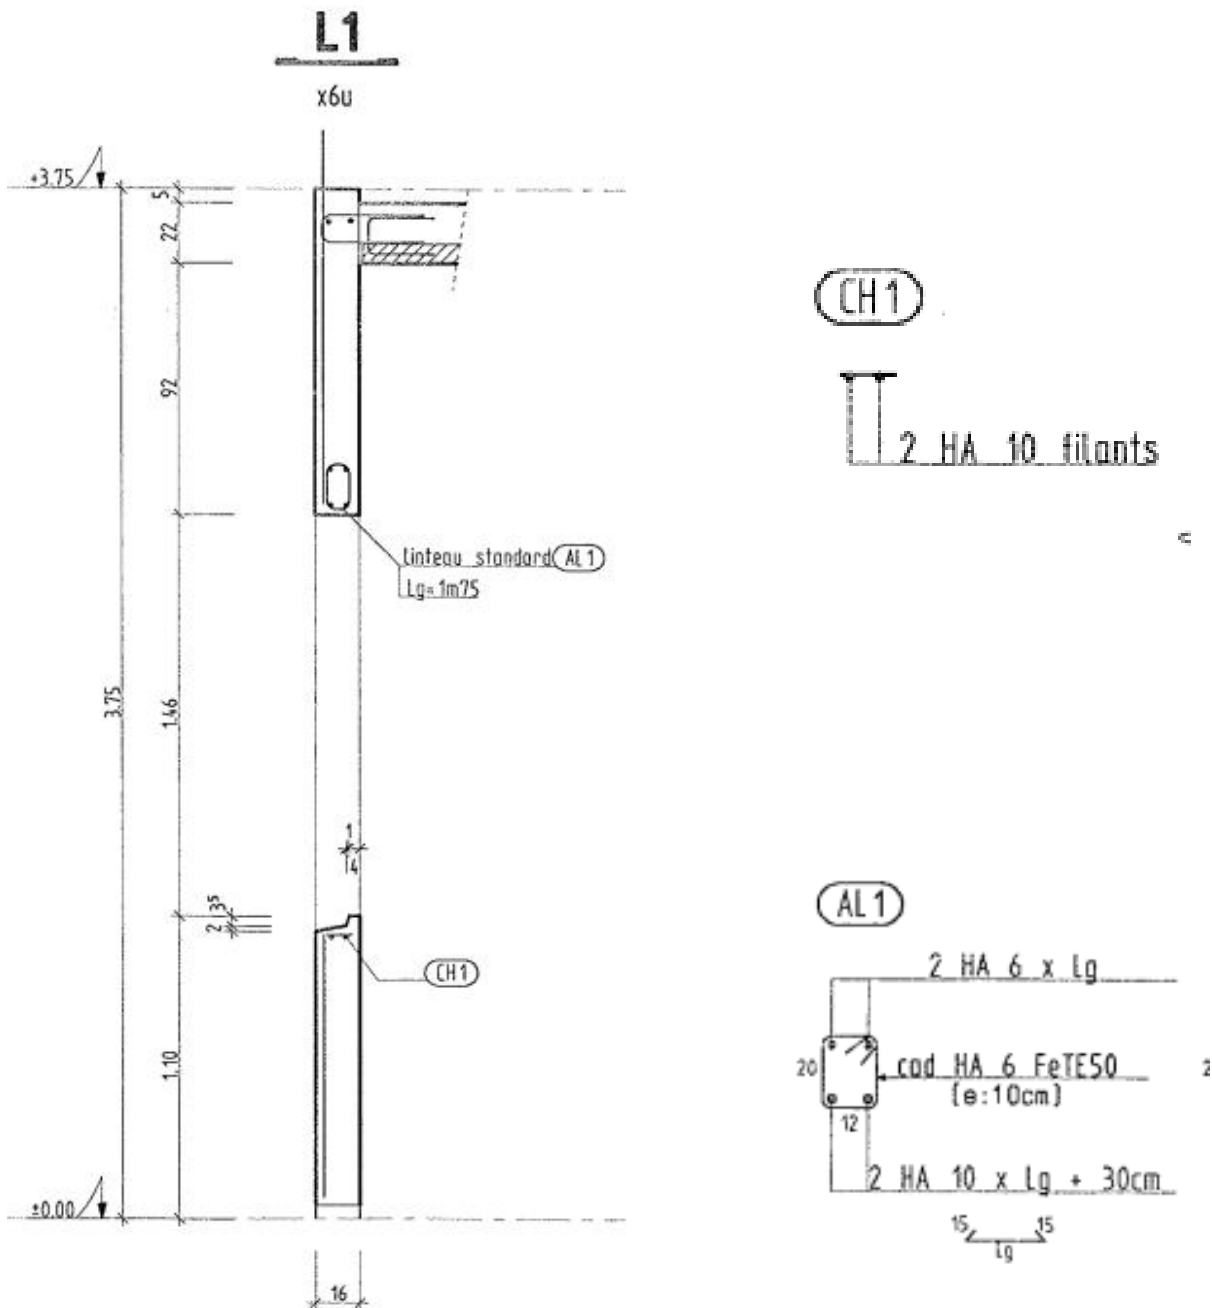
Ferrailage du linteau L1 / Plan 96.158 – EXE 12A
